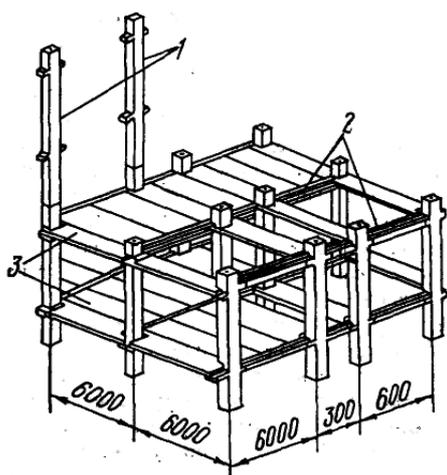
Схема каркаса одного яруса: 1 – колонны; 2 – ригели; 3 – плиты перекрытий
